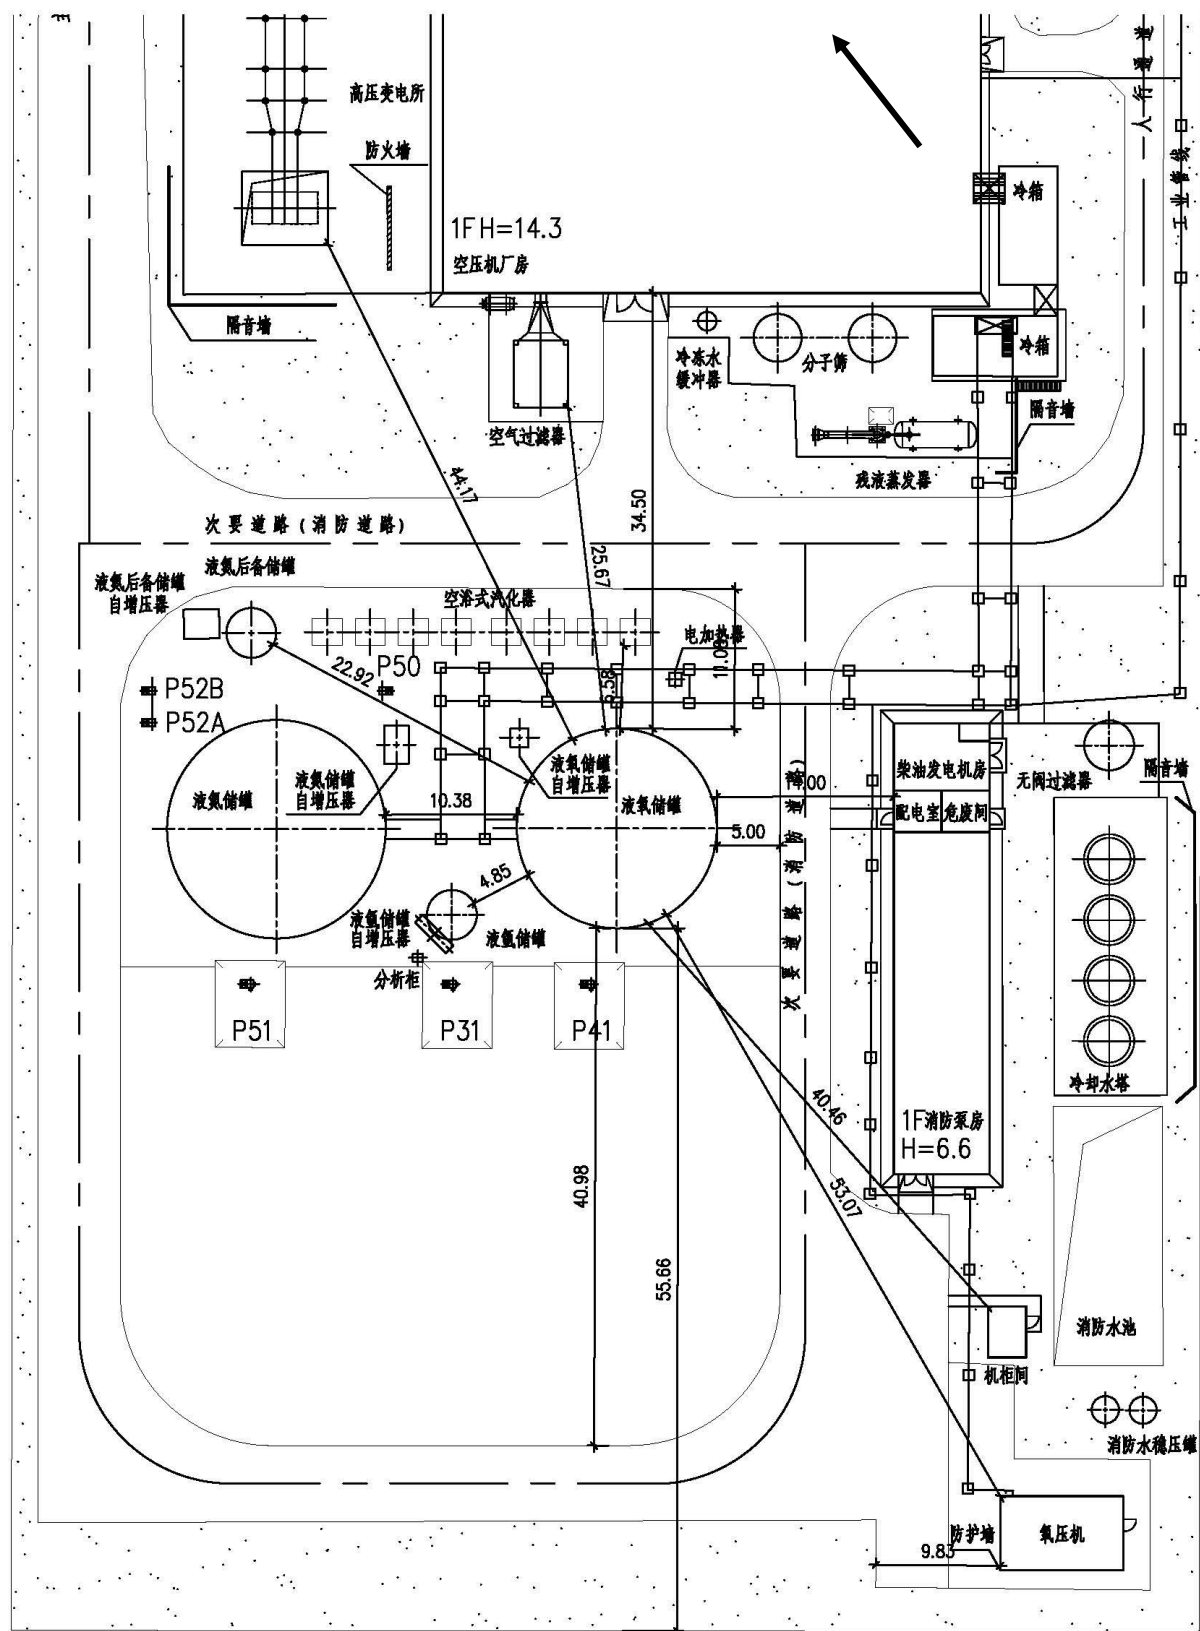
本项目平面布置示意图（单位：m，箭头指向为北）
